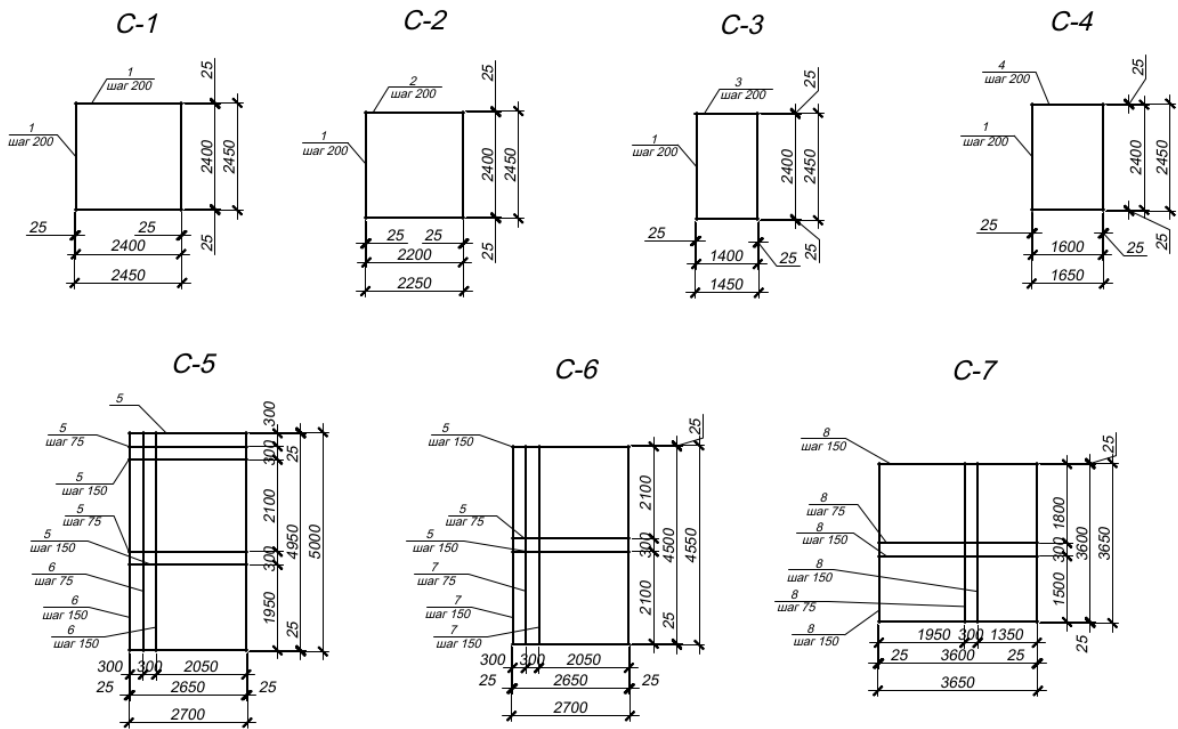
Конструювання арматурних сіток плити перекриття (C-1...C-7)
